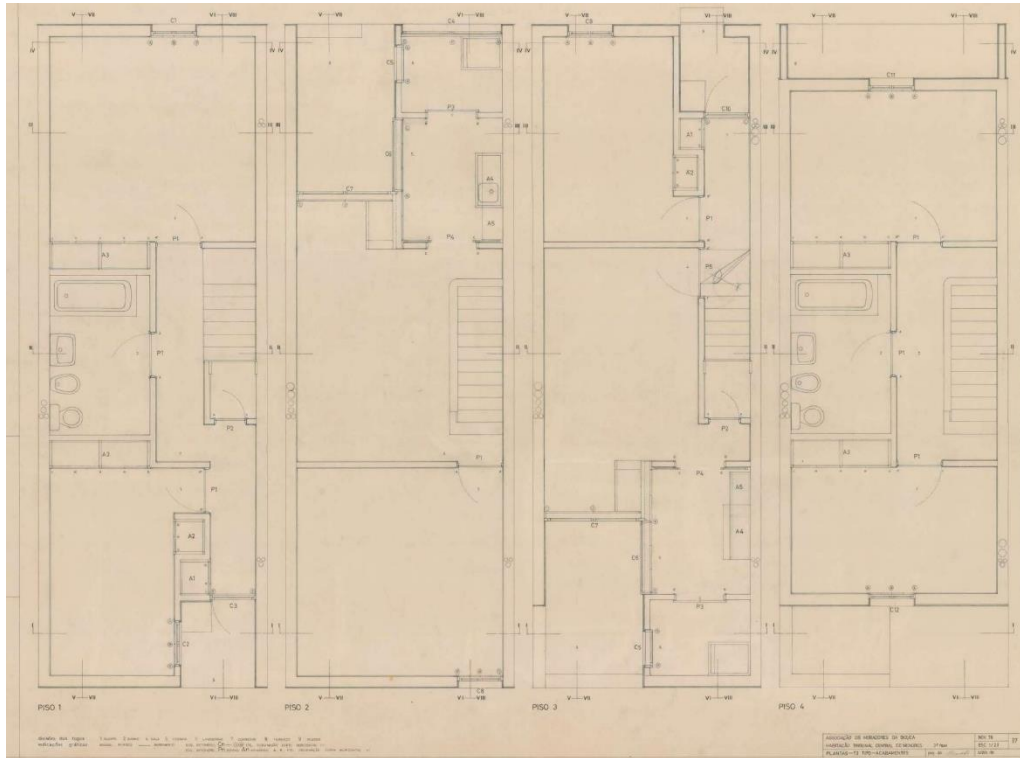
Planta tipo das tipologias propostas por Álvaro Siza, 1978.
